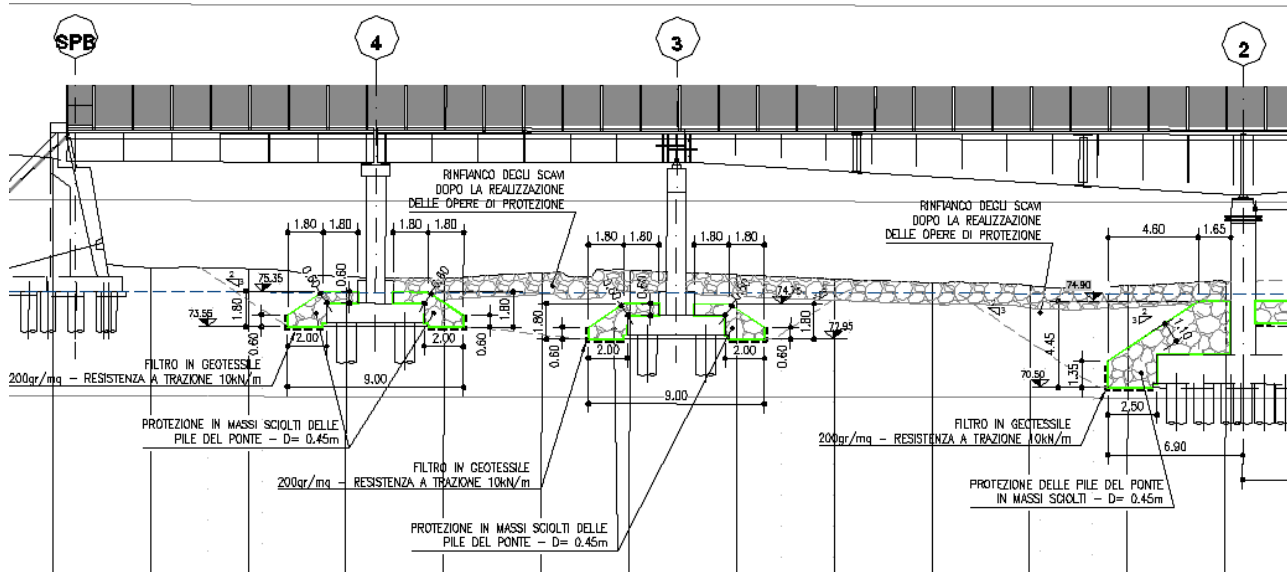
Sezione di progetto del rivestimento delle pile in area golenale nella sezione di monte del viadotto sul Fiume Lambro.
